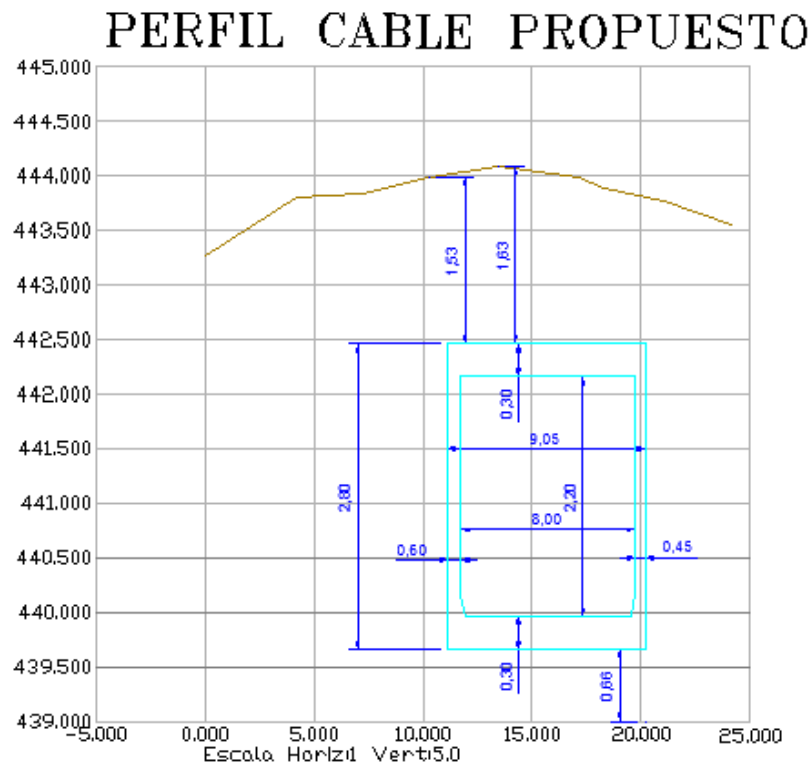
Perfil de la sección propuesta. Edet Av. Guzman.
